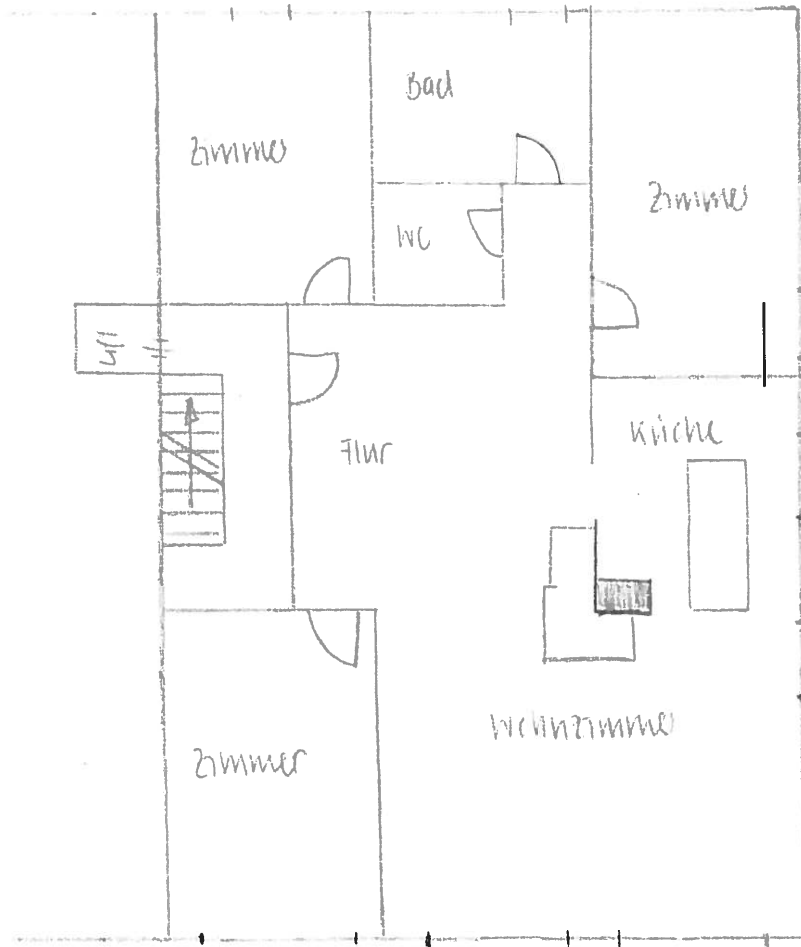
Grundriss 1. Dachgeschoss, Skizze IBID 2015. Auf dem Plan fehlt der Grundriss der ehemaligen Ökonomie.
